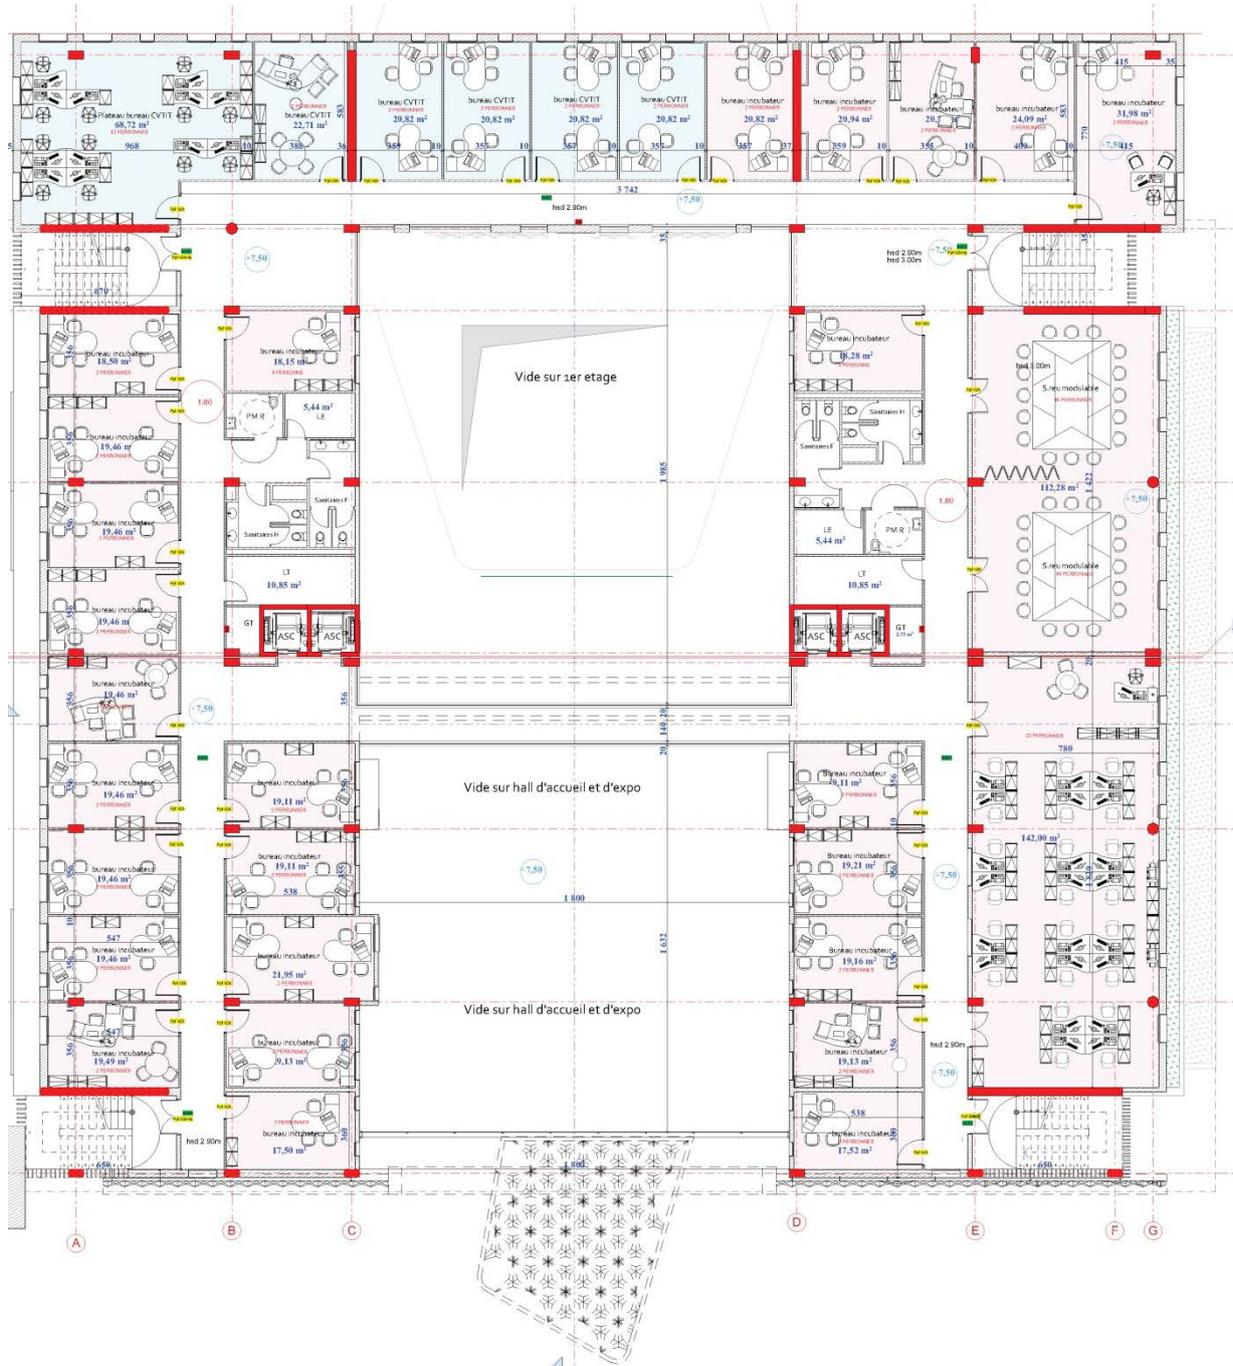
Plan masse du bâtiment de service et de l'innovation (2ème étage)
